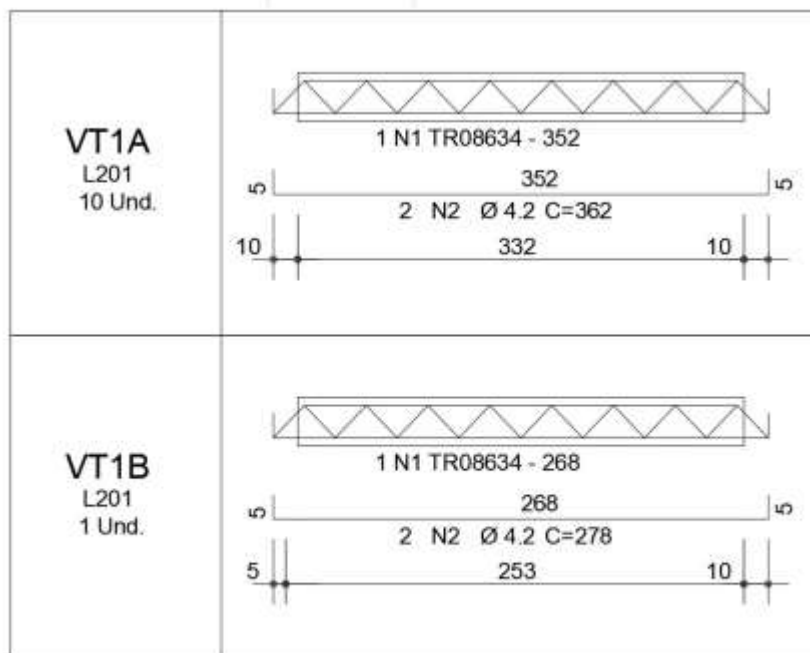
Vista do detalhamento da laje de tampa a ser construída. (Fonte: Próprio autor)
